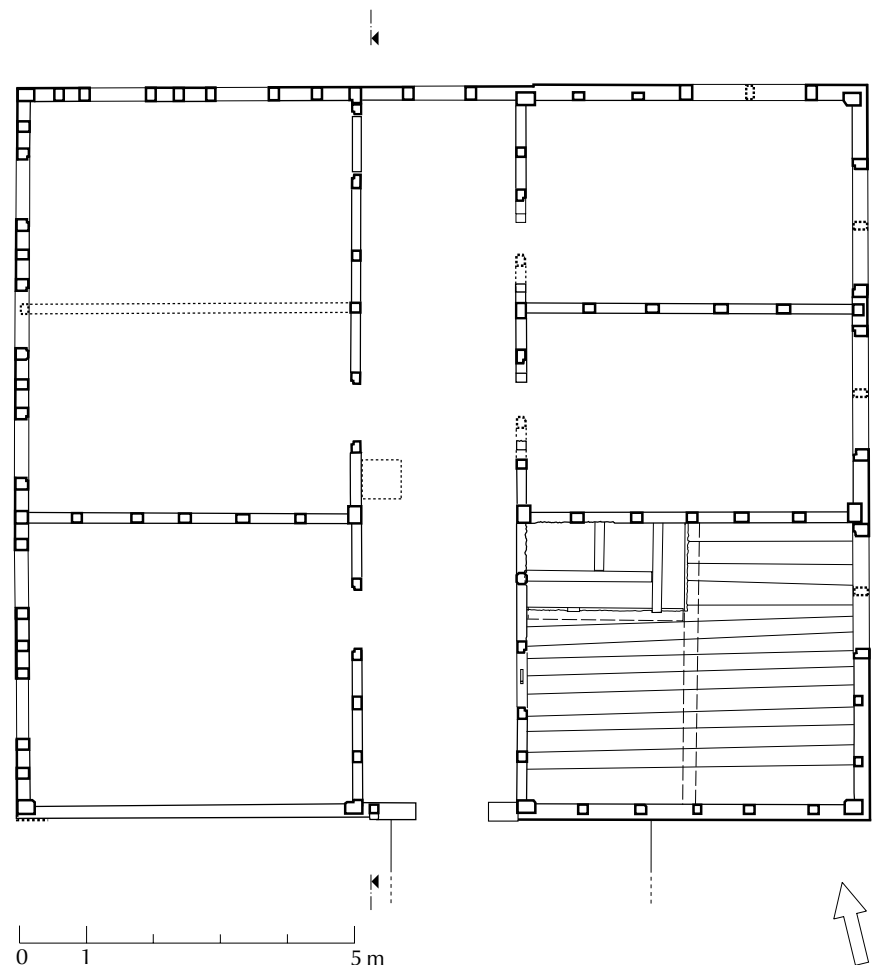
Grundriss des zweiten Wohngeschosses.
